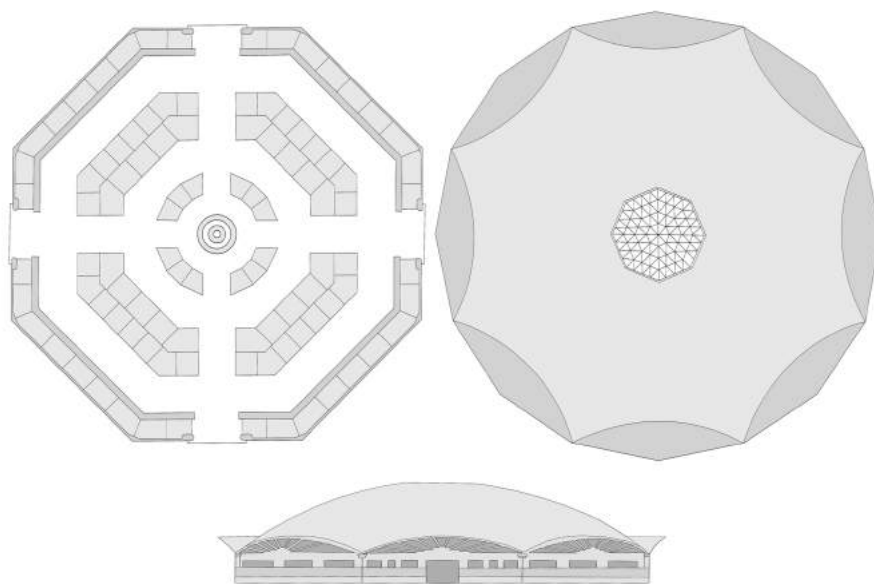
Mercado de Algeciras (Cádiz). Planta, alzado y cubiertas. Eduardo Torroja Miret, ingeniero y Manuel Sánchez Arcas, arquitecto. 1935
